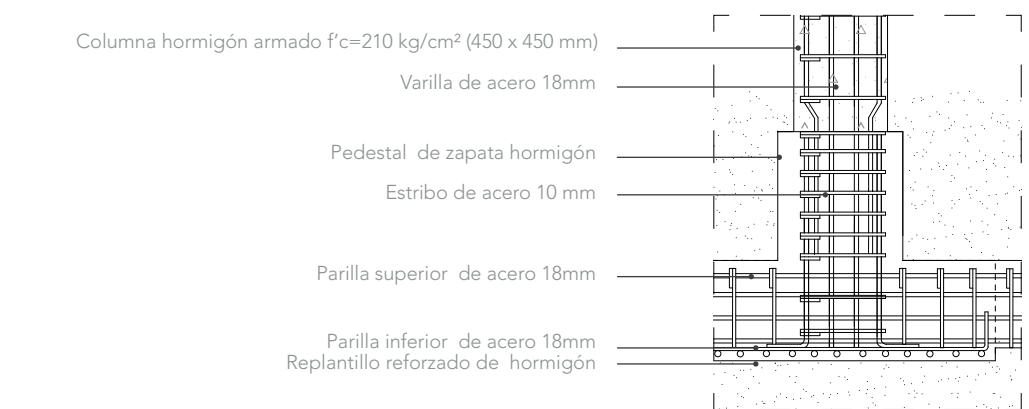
Detalles constructivos, D-1 Fuente: elaboración propia, 2024.
